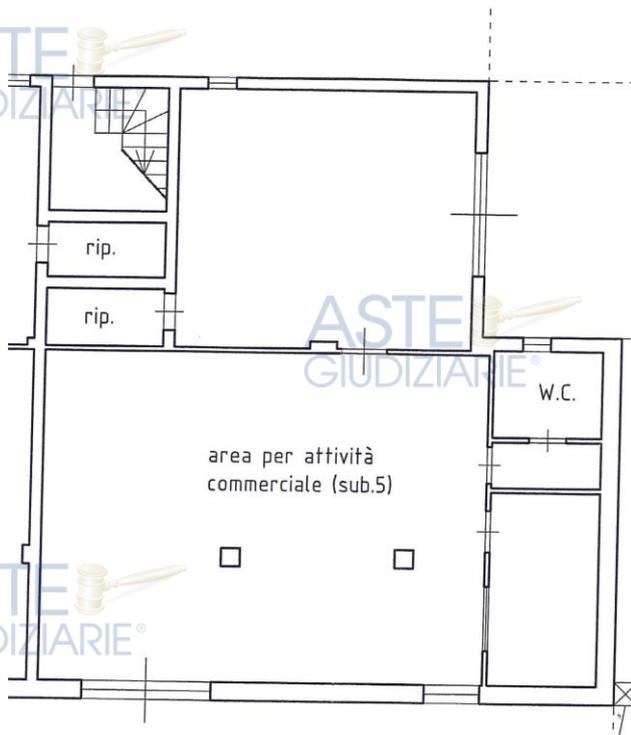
"Planimetria allegata alla pratica Prot. N. 13016 del 17.06.2009"
